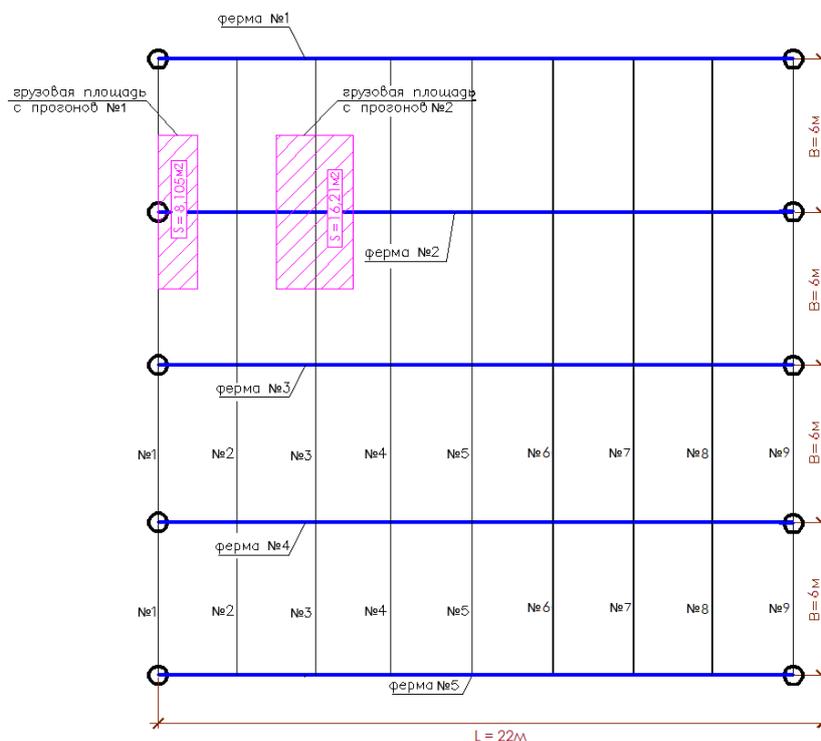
Грузовая площадь верхнего пояса фермы
